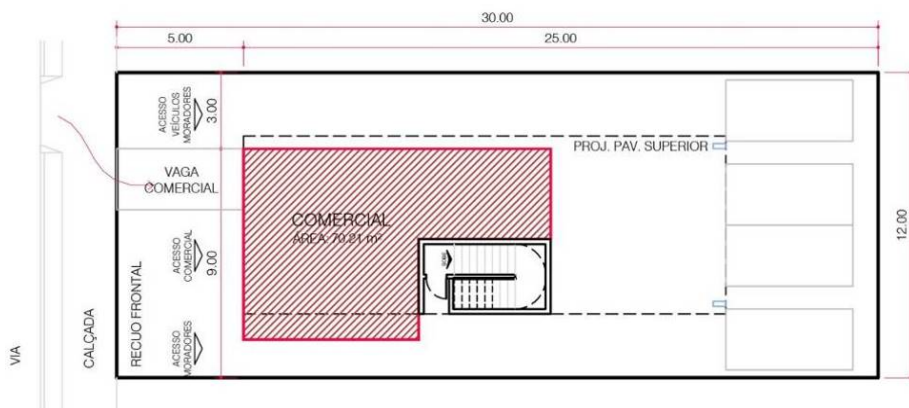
Plantas baixas e cortes do edifício misto sem subsolo em lote de 360m²
